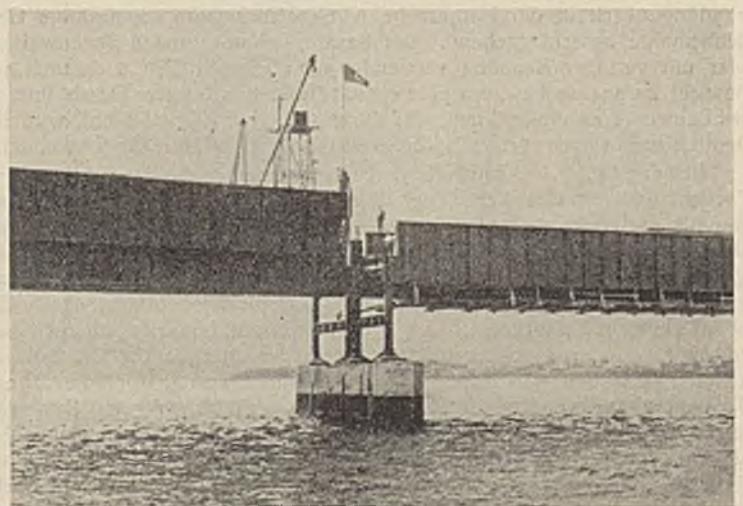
Der Eisenbahnüberbau (Anteil Krupp) erreicht den Pfeiler 5.
